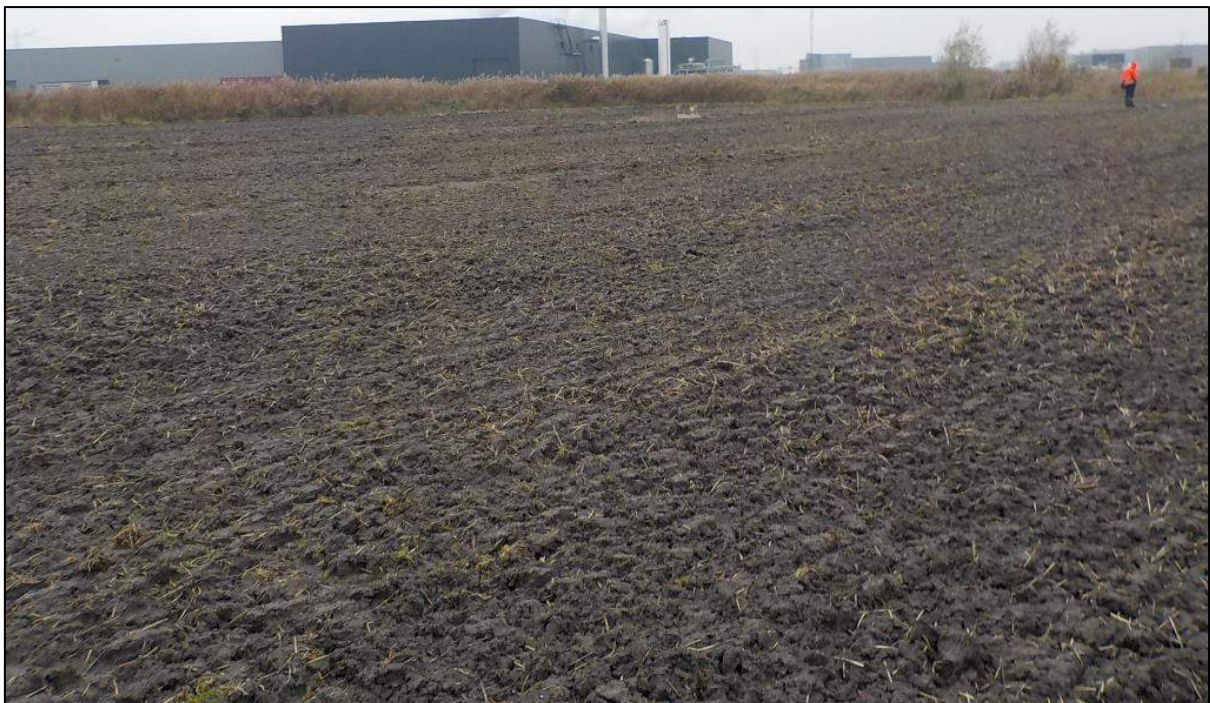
Overzichtsfoto onderzoekslocatie zuidwest gericht genomen
